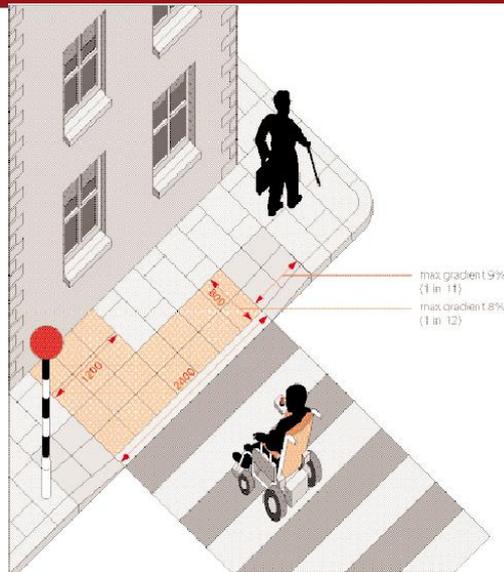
Esquema ilustrativo para la colocación de rampas de acceso y pavimento táctil para usuarios discapacitados.
